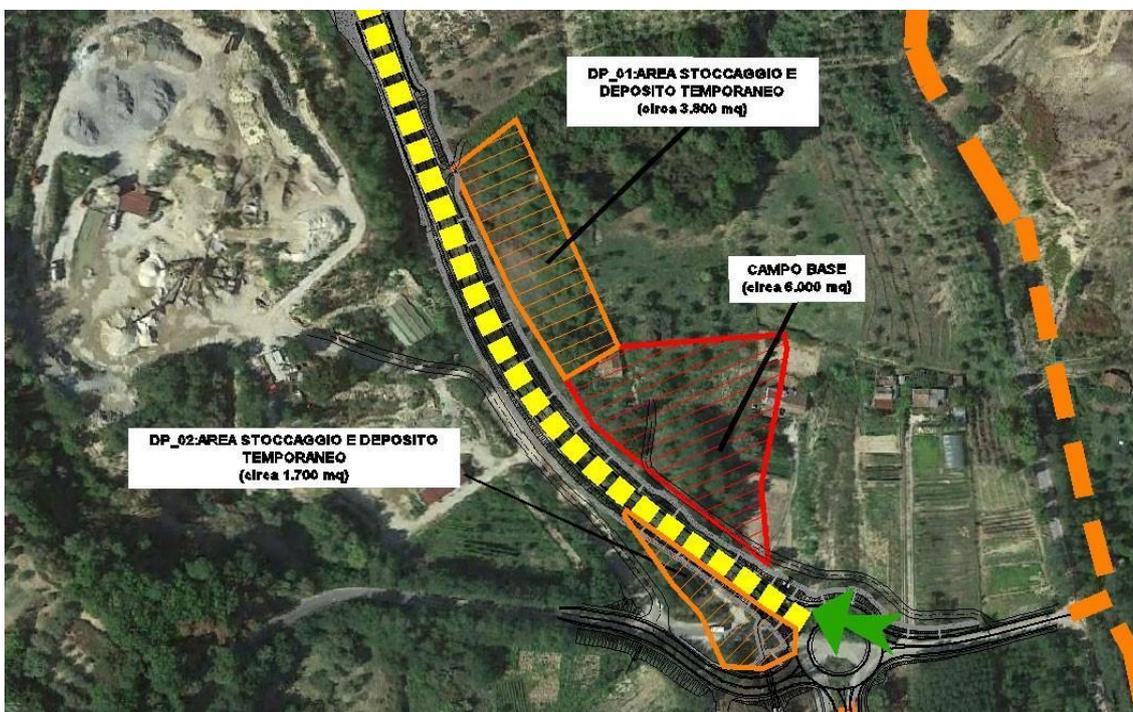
Estratto elaborato Planimetria di cantiere e viabilità (T00CA01CANPL01\_A) con indicazione della località Rosco
